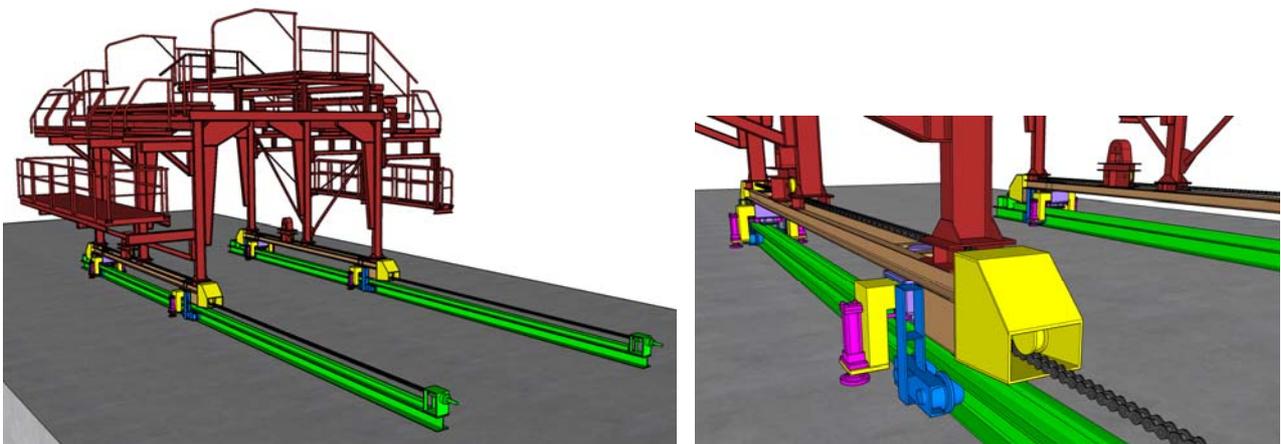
Rail Walker System のイメージ図(作業台車での採用例)
